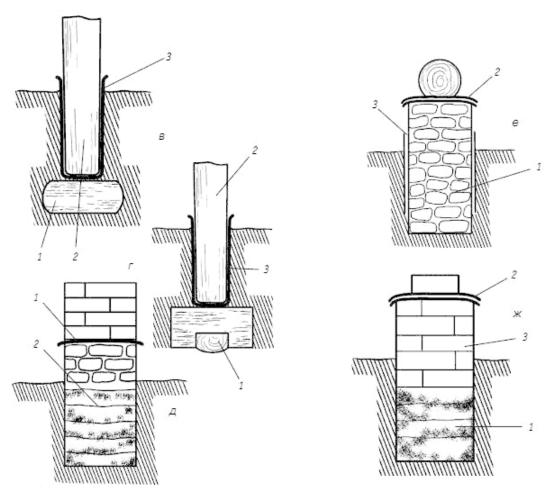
Фундаменты (продолжение): в — деревянный стул на камне: 1 — камень; 2 — комлевая часть бревна; 3 — гидроизоляция;
